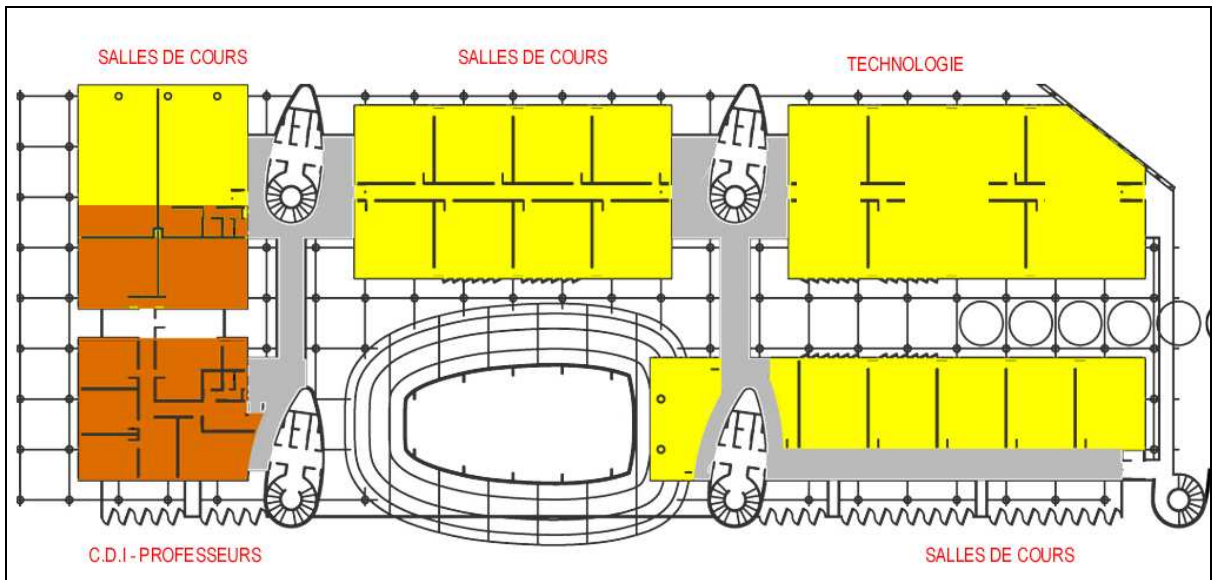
Collège Guy Dolmaire, plan R+1.
